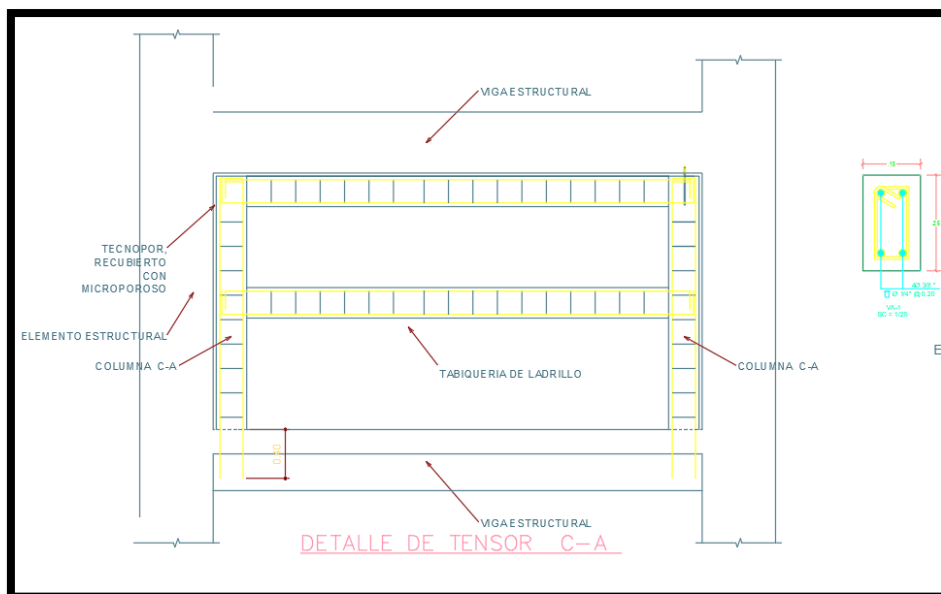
Detalle de tensor de albañilería, y confinamiento de muro estructural.
